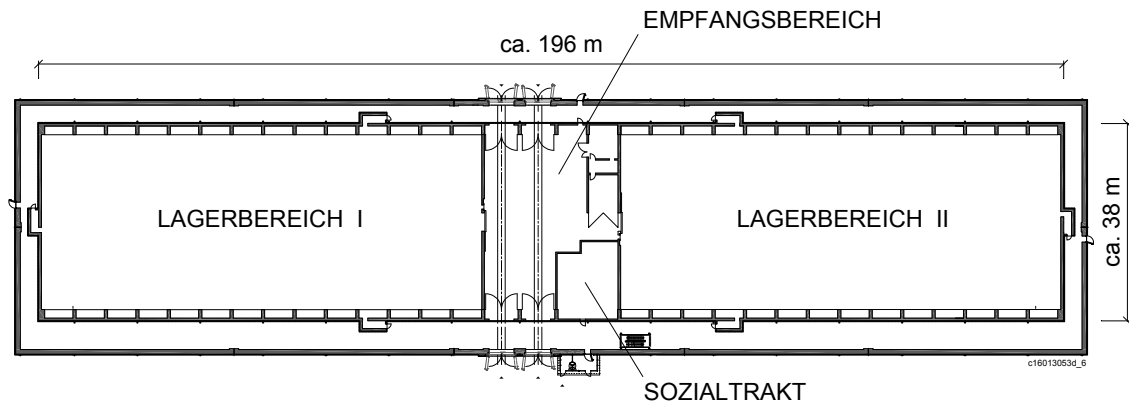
Lagerhalle mit Schutzwand, Grundriss
